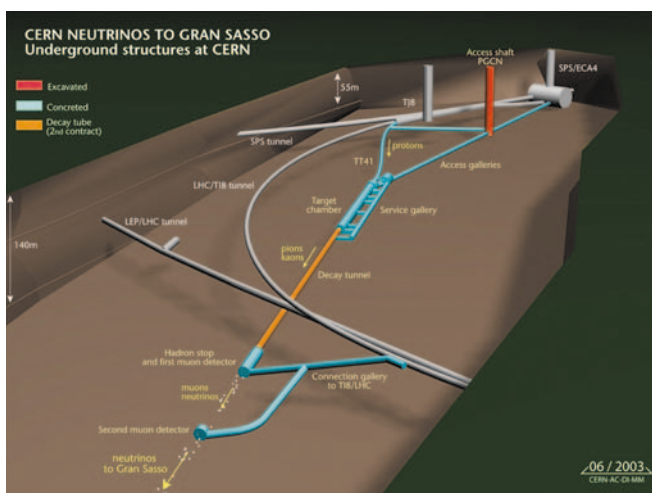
Veduta schematica delle strutture sotterranee di CNGS con il canale di estrazione dall'SPS, la zona bersaglio per la produzione dei neutrini e il tunnel di decadimento dei pioni (foto CERN)
